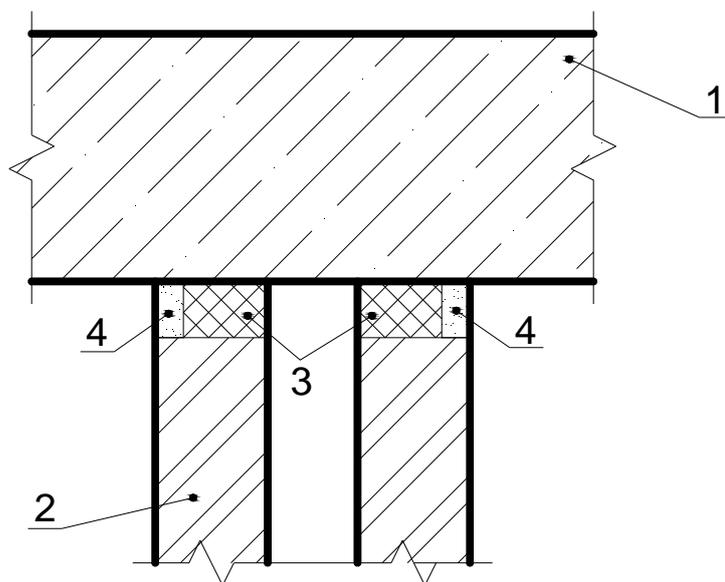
Схема конструктивного решения узла примыкания двойной перегородки к перекрытию:
